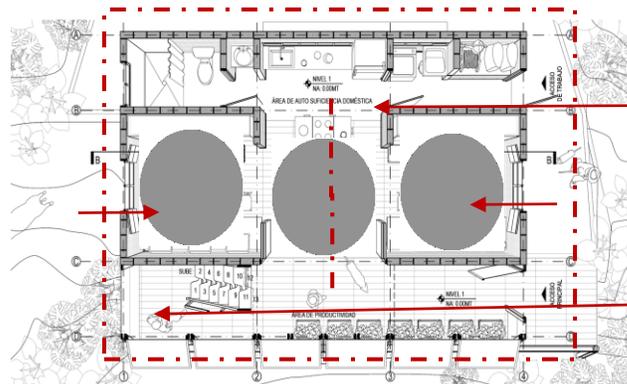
Primer planta, (2009) archidaily. modificaciones, Autoría propia
